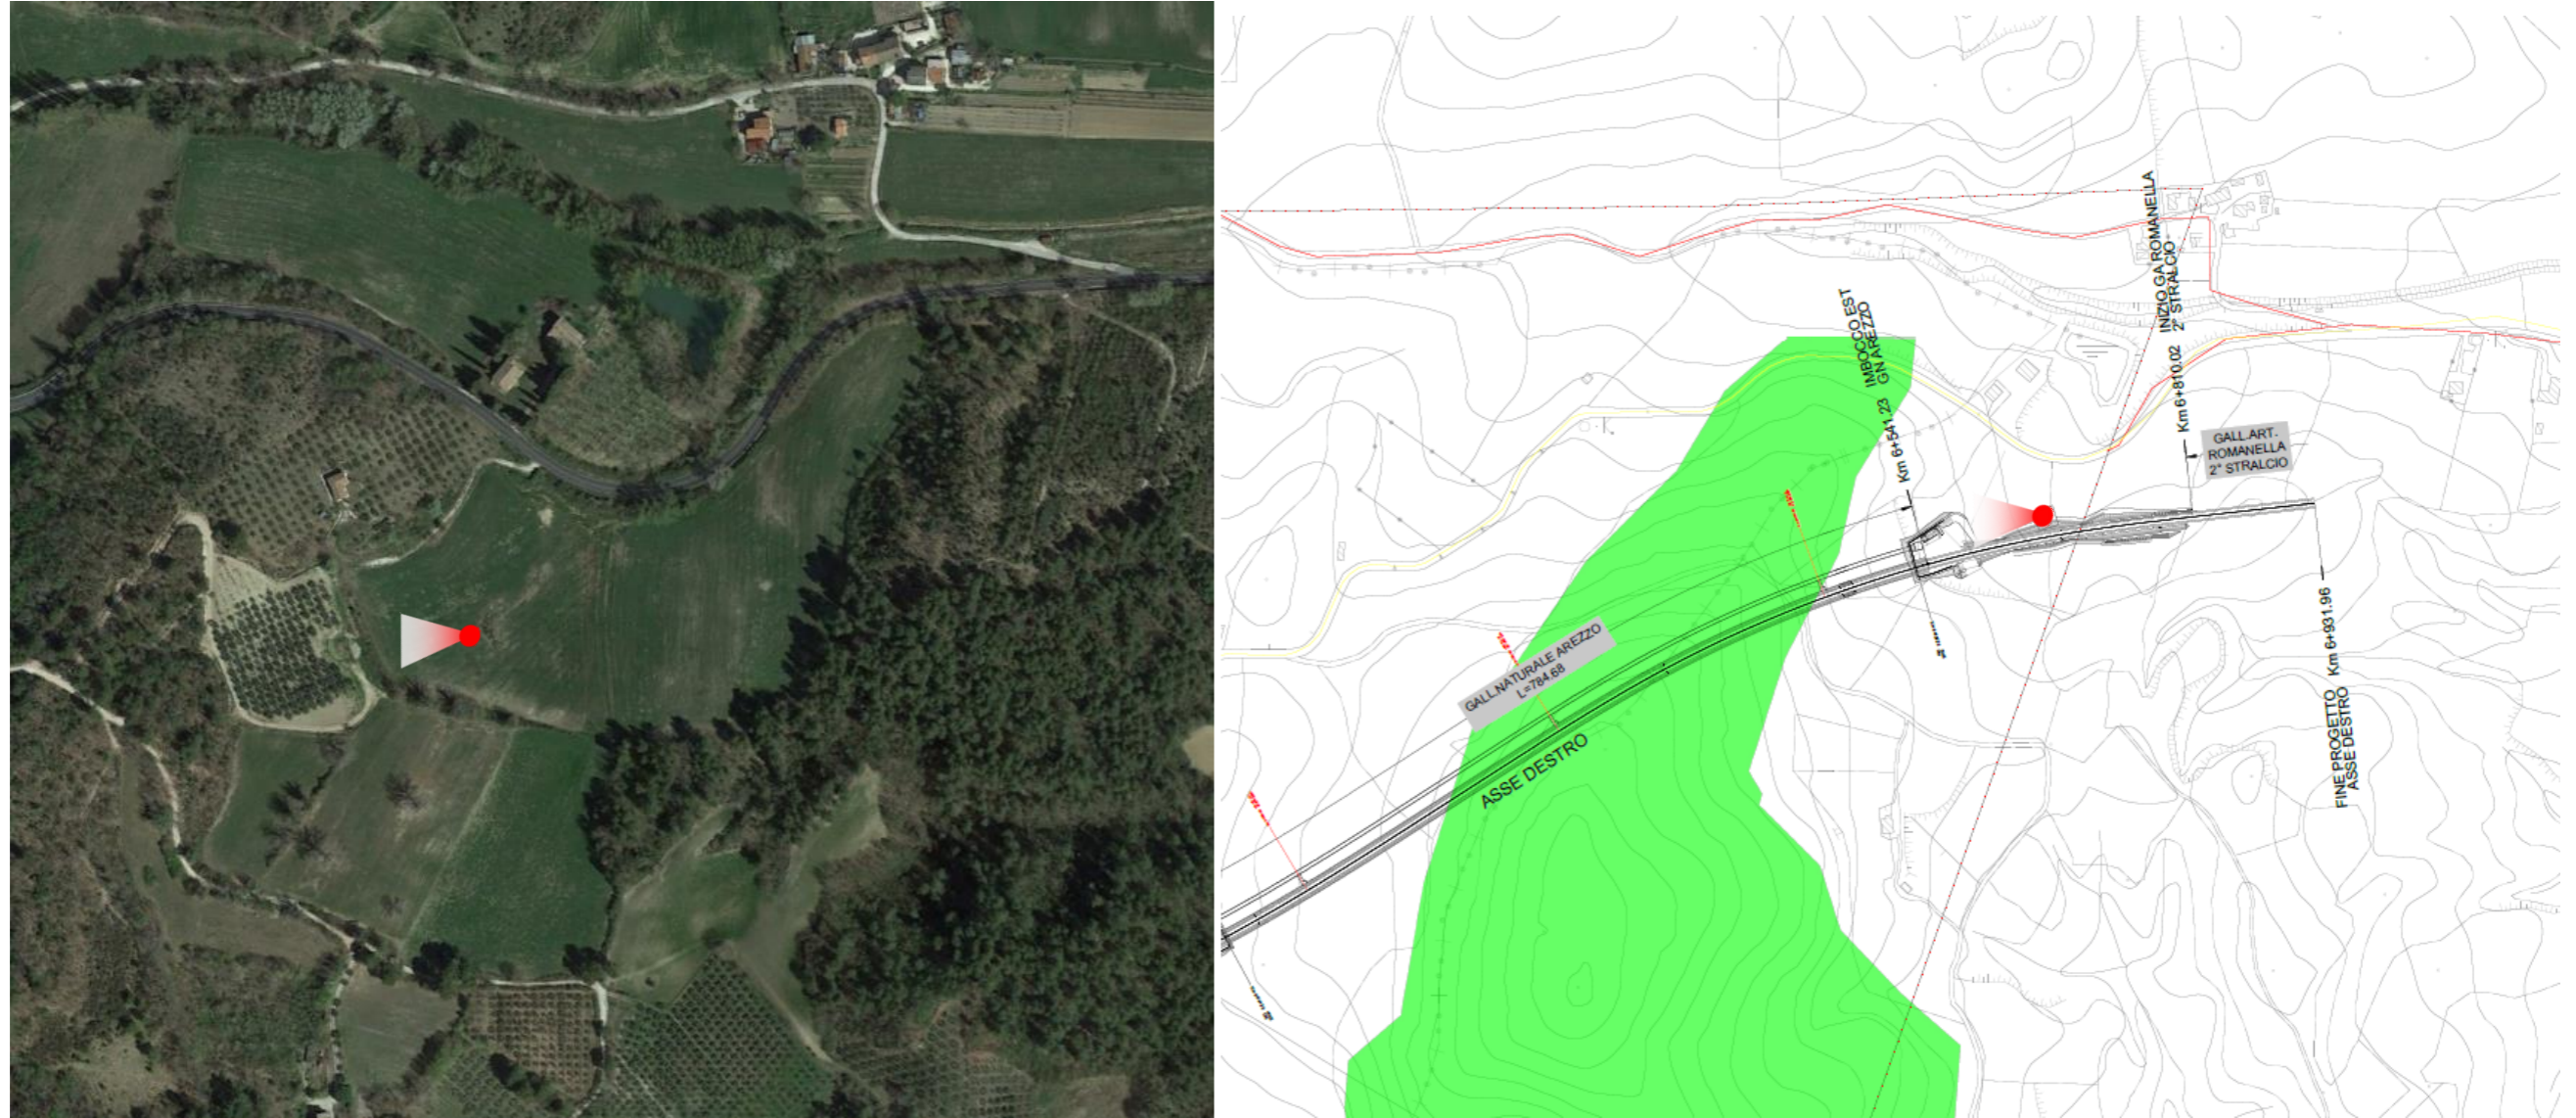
Rappresentazione del punto di vista del fotoinserimento 4 su ortofoto e su planimetria di progetto
